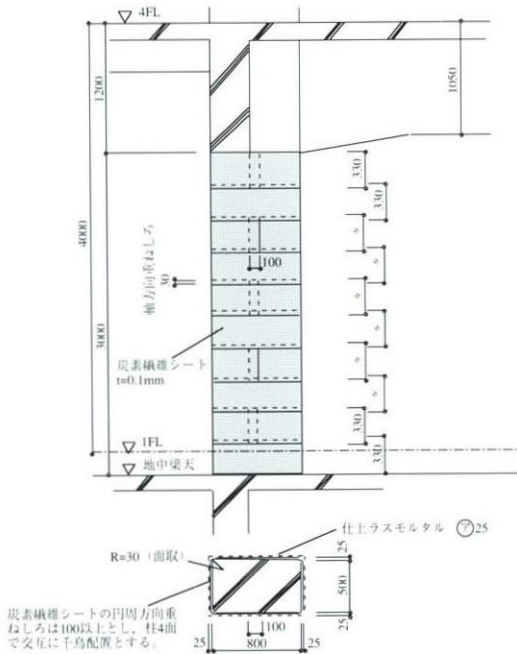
炭素繊維シートによる補強 Jacketing by CF Sheet on Column
